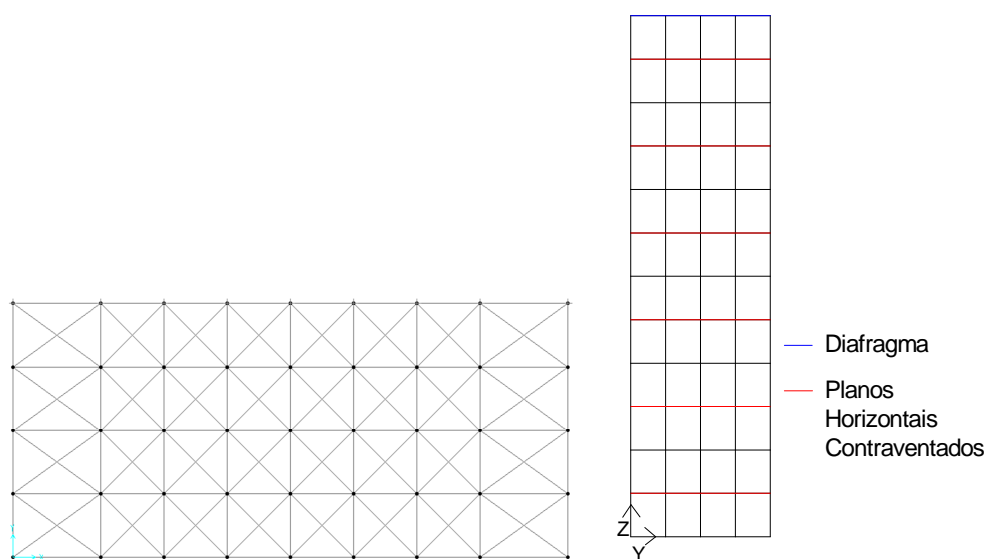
Configuração dos Planos de Contraventamento Horizontal Com Elementos de Contraventamento Pequenos
